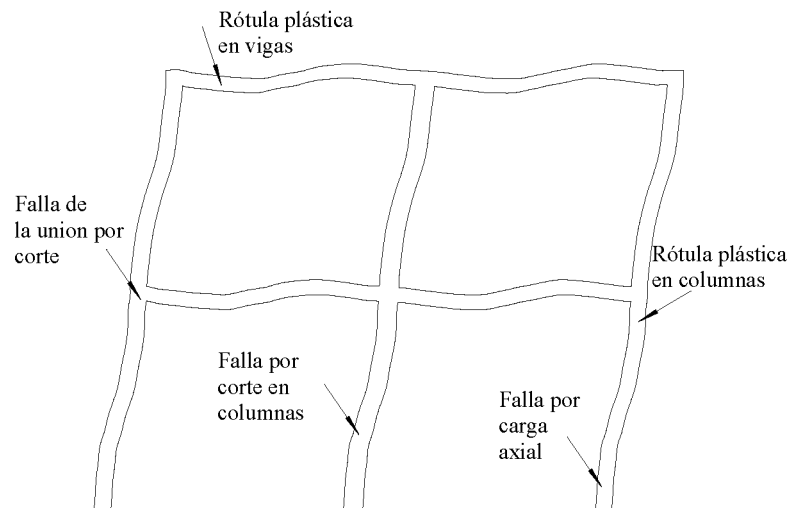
Formas de falla en elementos estructurales de concreto armado.
